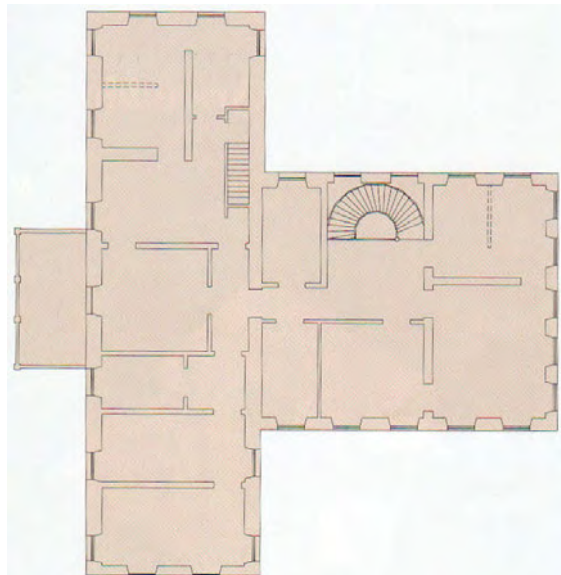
CASA 1893, AV. 17 de AGOSTO, RECIFE – PE, PLANTA BAIXA DO PAVIMENTO SUPERIOR.
